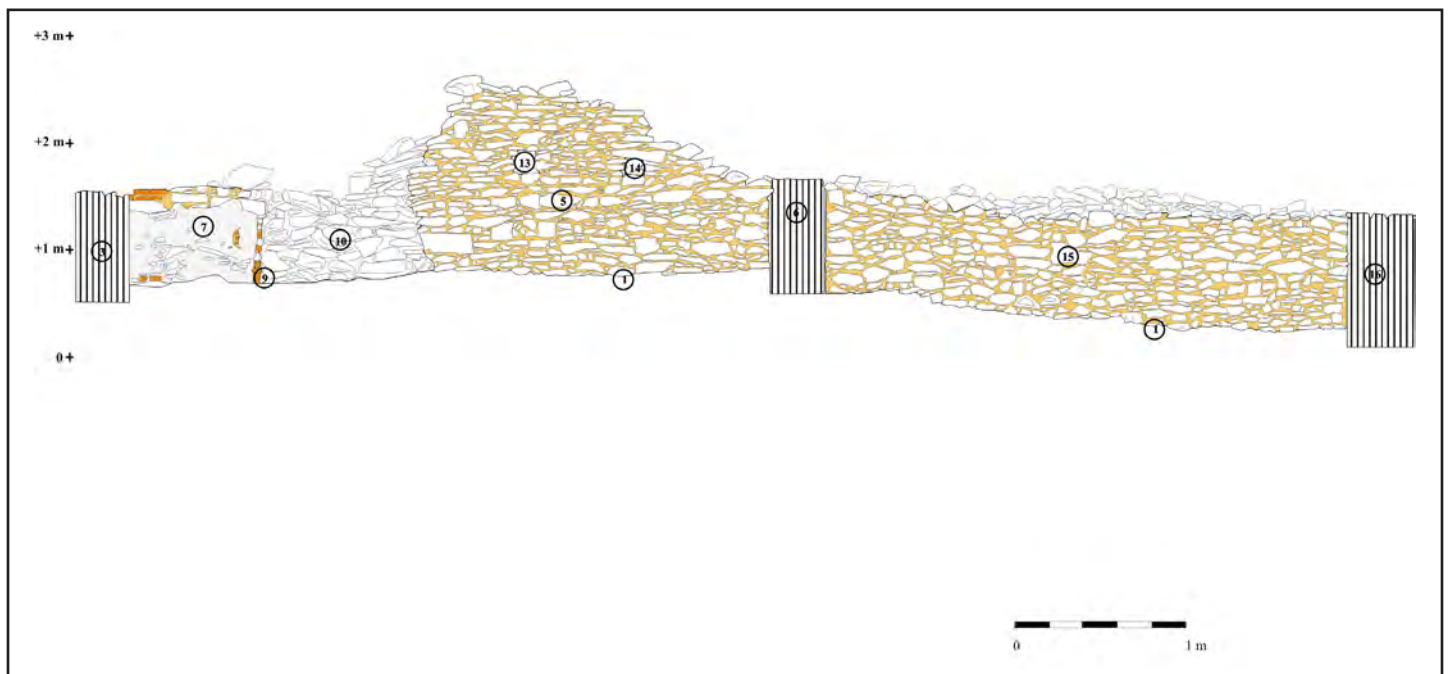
Alzado sur de las UU.EE. 4, 5, 7, 9, 10 y 13-15 de la Estructura B (escala 1:20).
